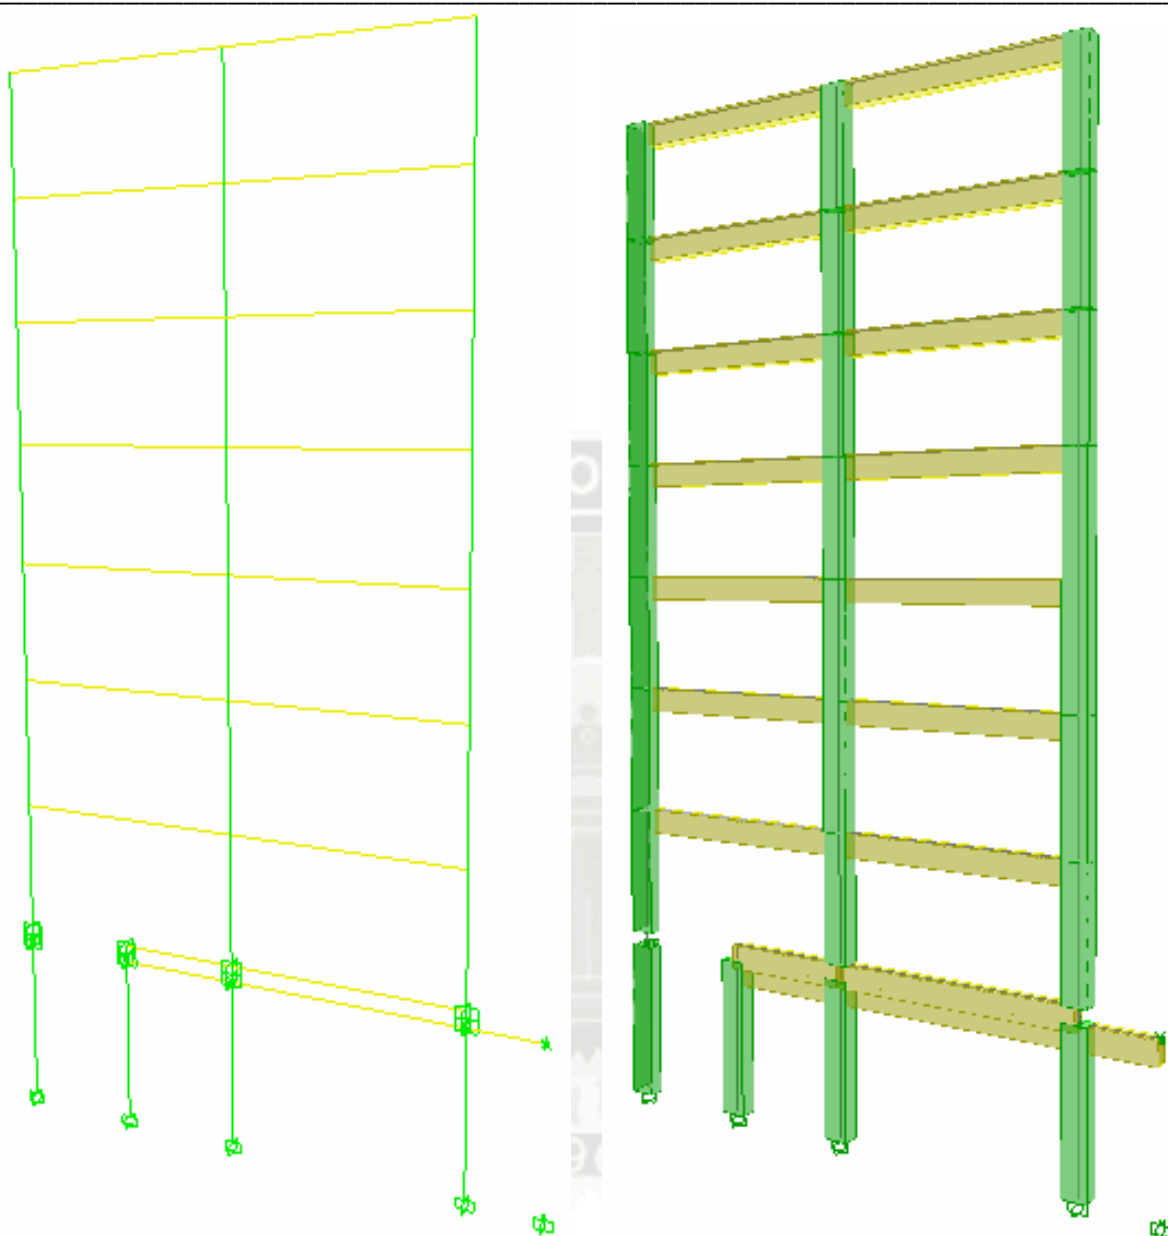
k. Vista Elevación Eje 2-2
